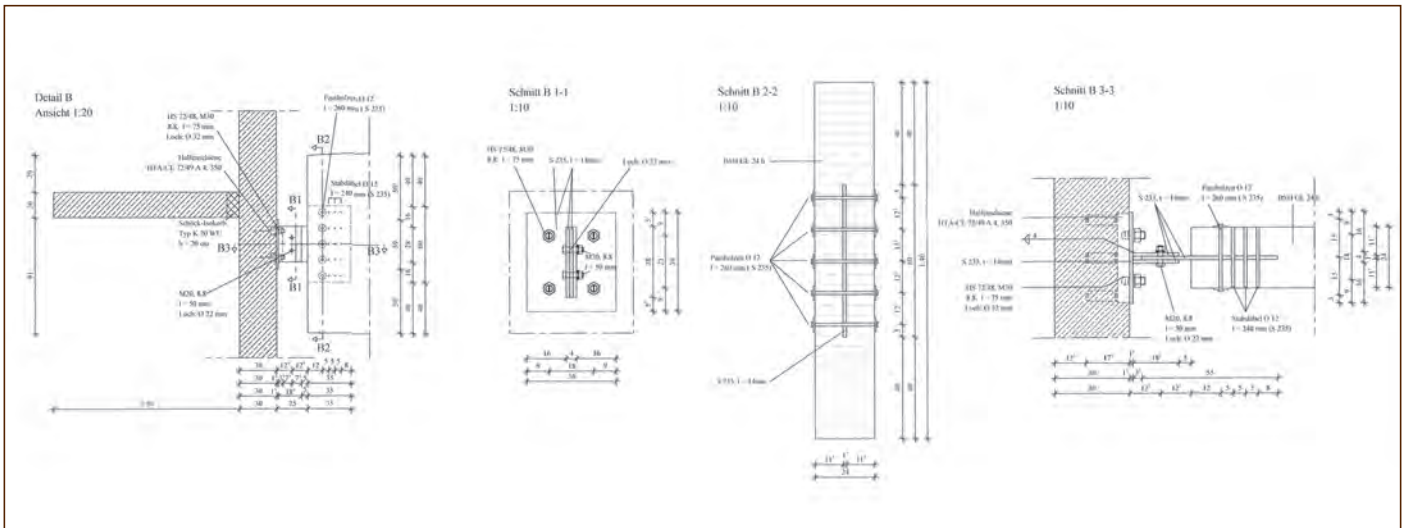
Details Anschluss Deckenbalken an Wand, Projekt 2 – Sporthalle WS 2014/15, Verfasser: Arne Wittenborn (Bachelor Architektur) und Michael Adelung (Bachelor Bauingenieurwesen), betreut an den Lehrstühlen Baukonstruktion und Stahlbau
